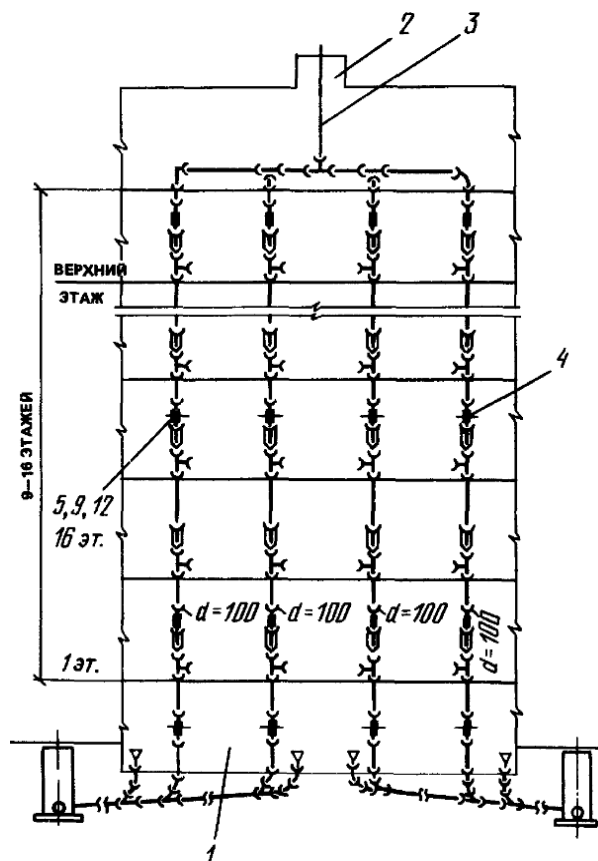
Схема объединения вентиляционных канализационных стояков в жилом здании: 1 – техническое подполье (подвальный этаж); 2 – вентиляционная шахта теплого чердака; 3 – общий вытяжной стояк; 4 – этажестояки в санитарно-технических кабинетах
